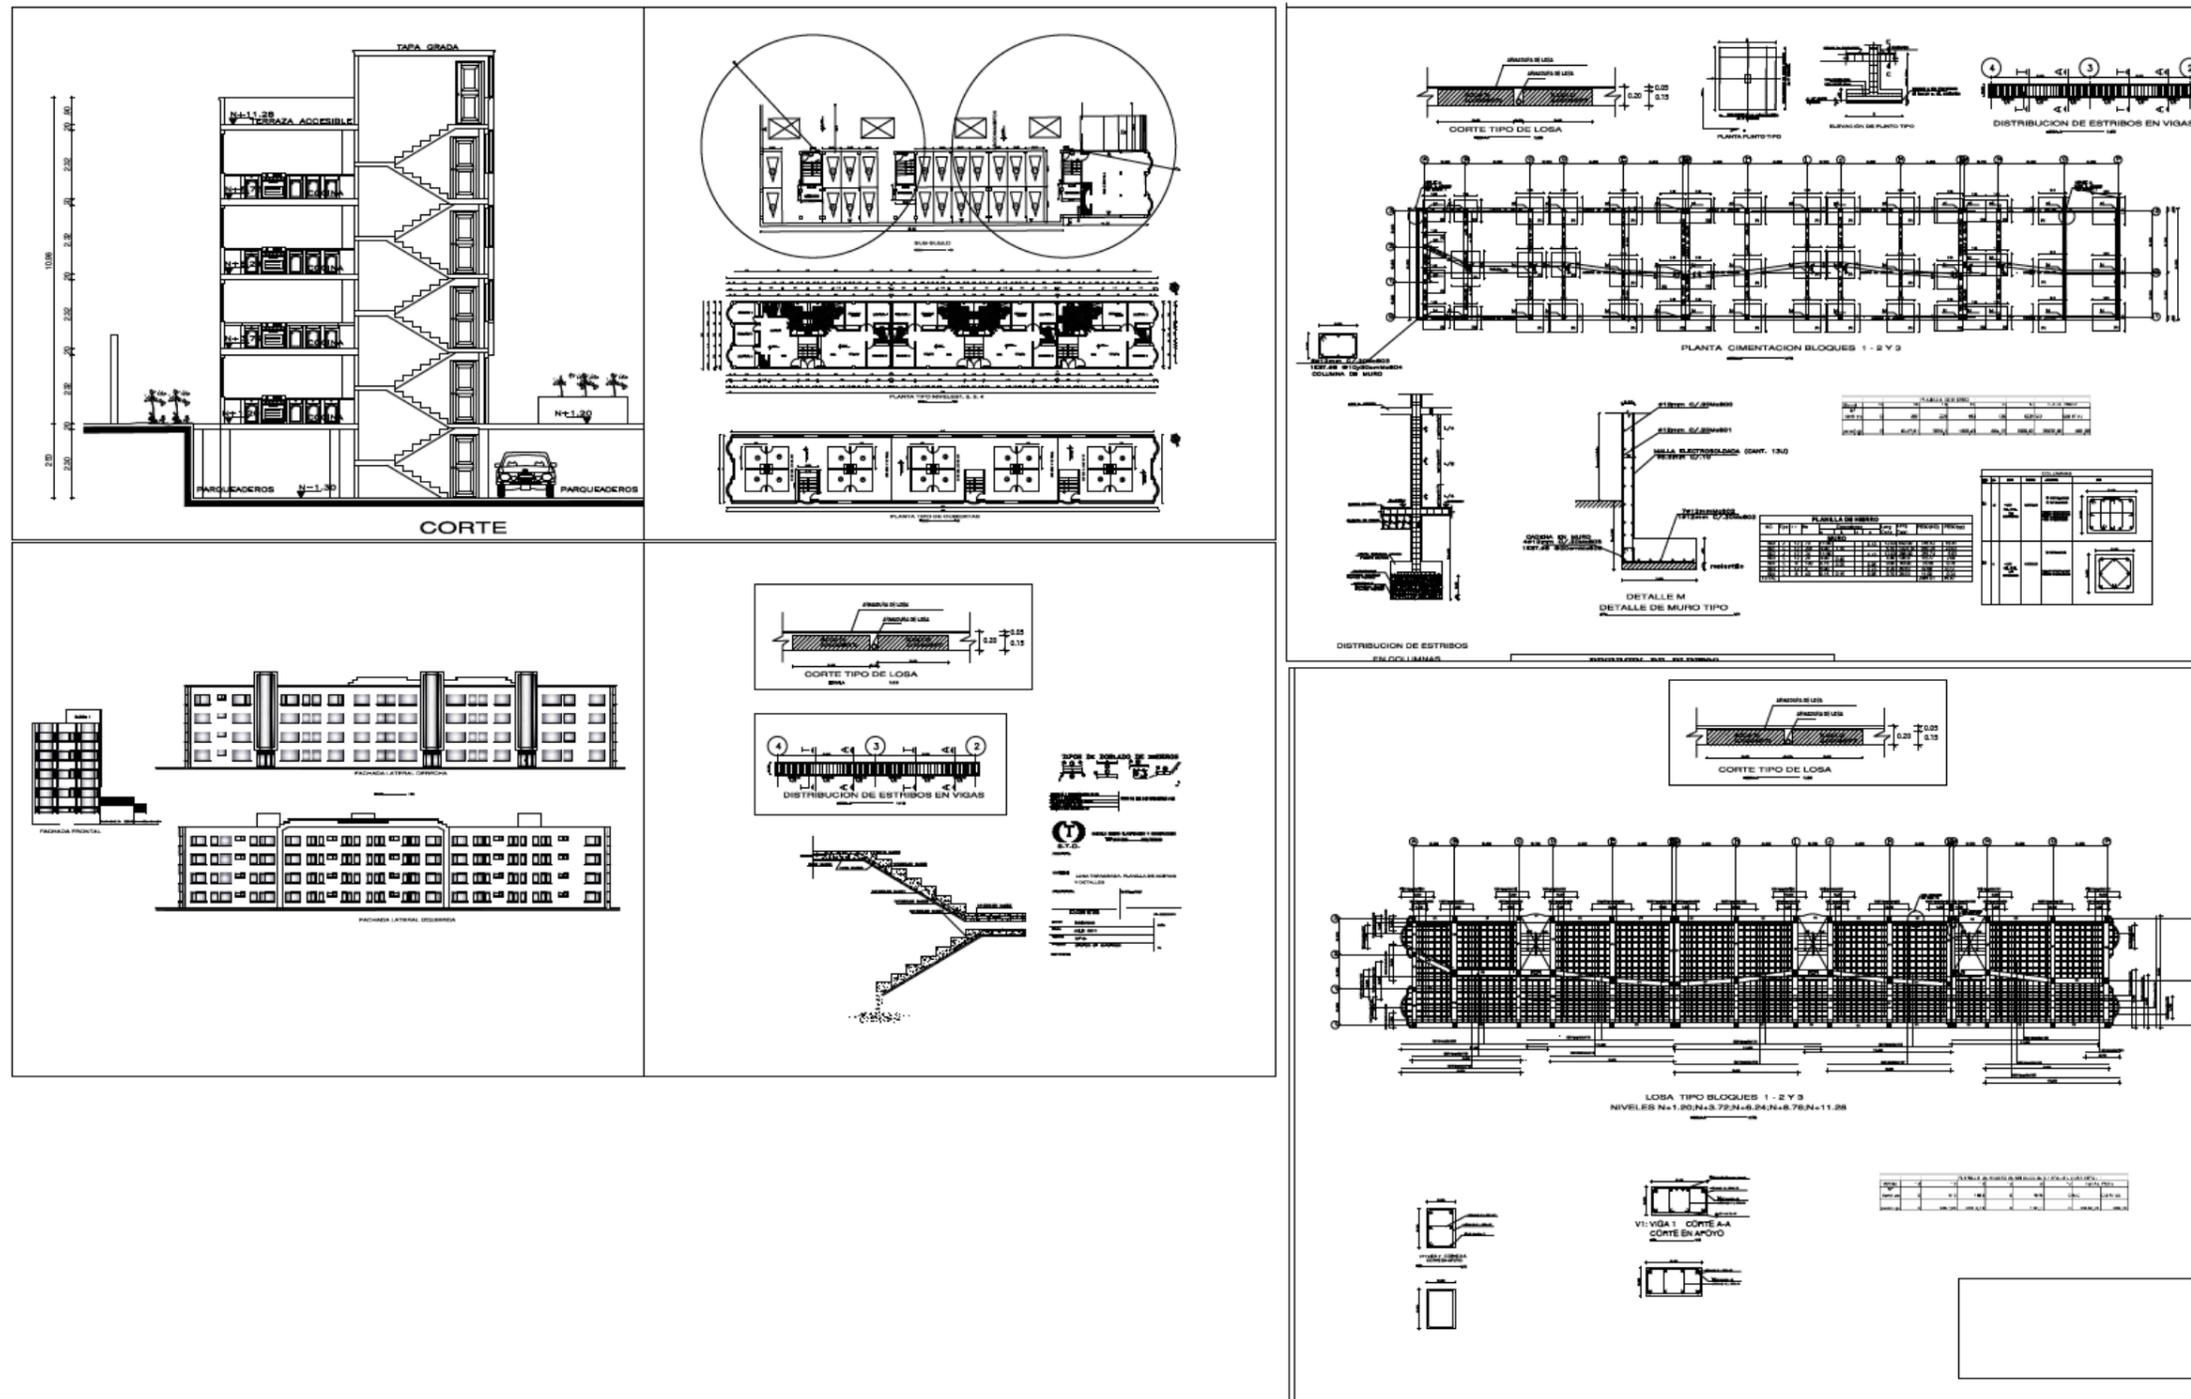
PLANOS DE DETALLE DEL PROYECTO
